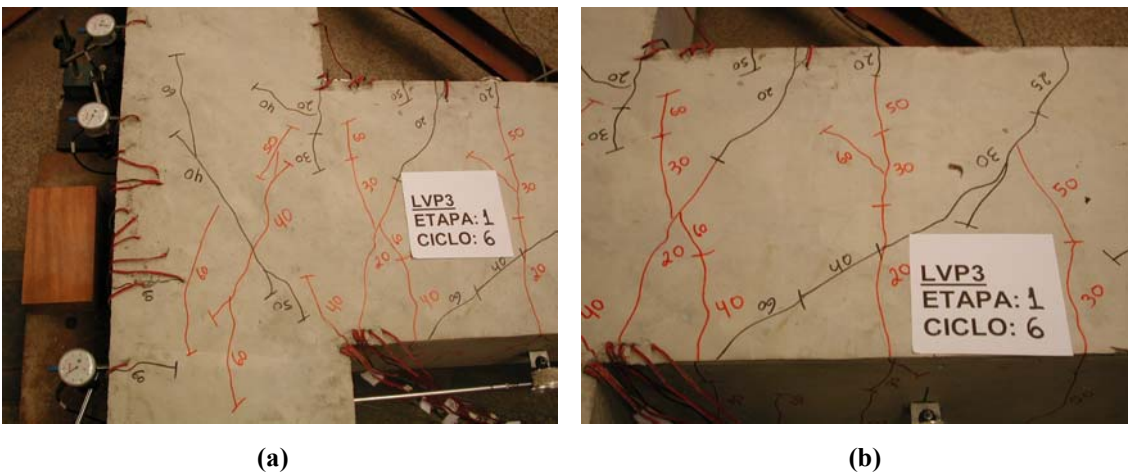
Detalhe das fissuras do pórtico de Alva, $F = \mp 60\text{KN}$: (a) nó, (b) viga
